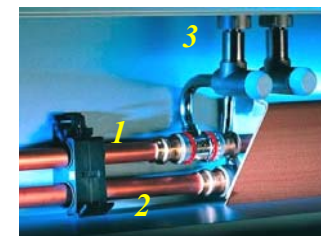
Схема присоединения современного отопительного прибора к двухтрубной горизонтальной системе отопления:
